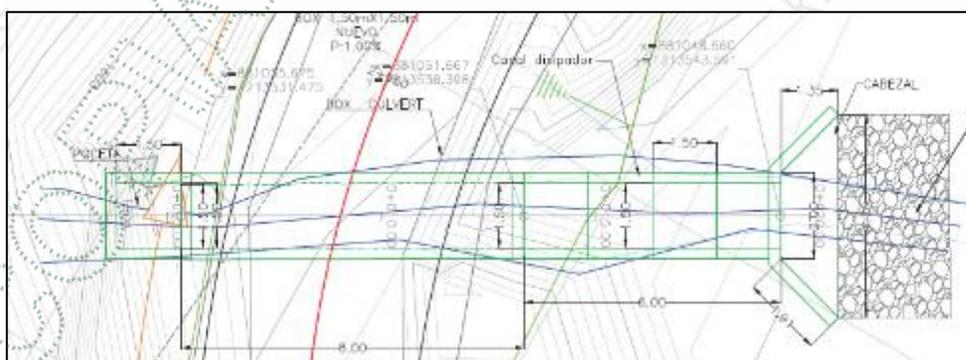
(36)		Tipo de la obra				Box Culvert abscisa K02+603
